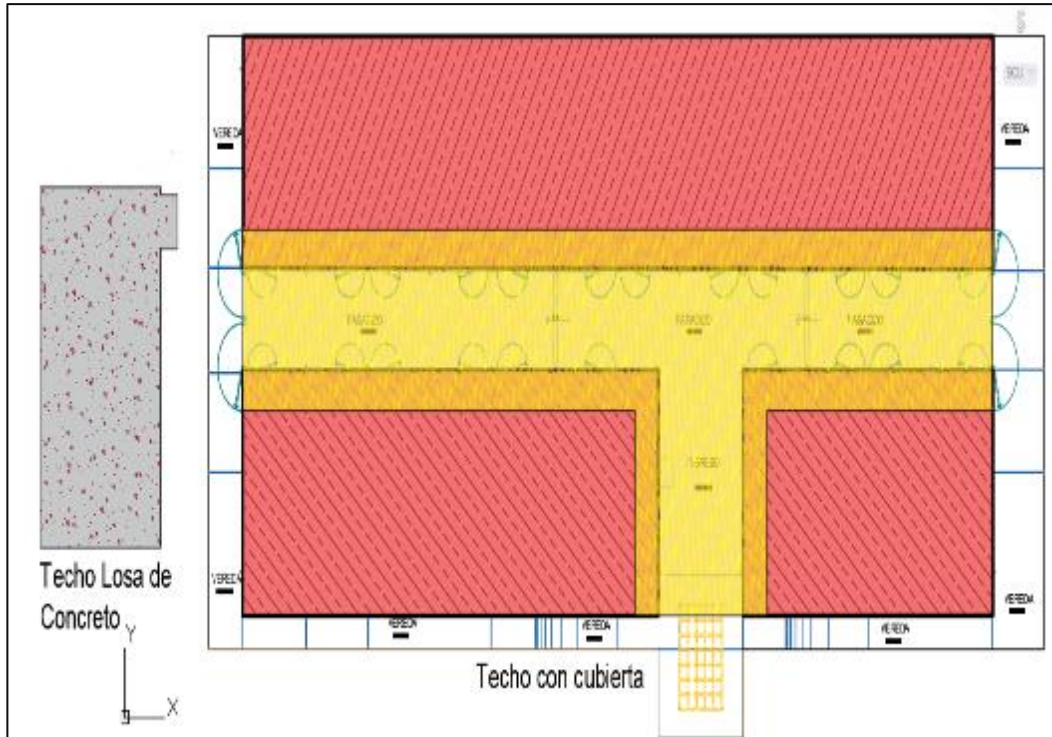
Vista en planta del techo del pabellón K- FIUPLA
